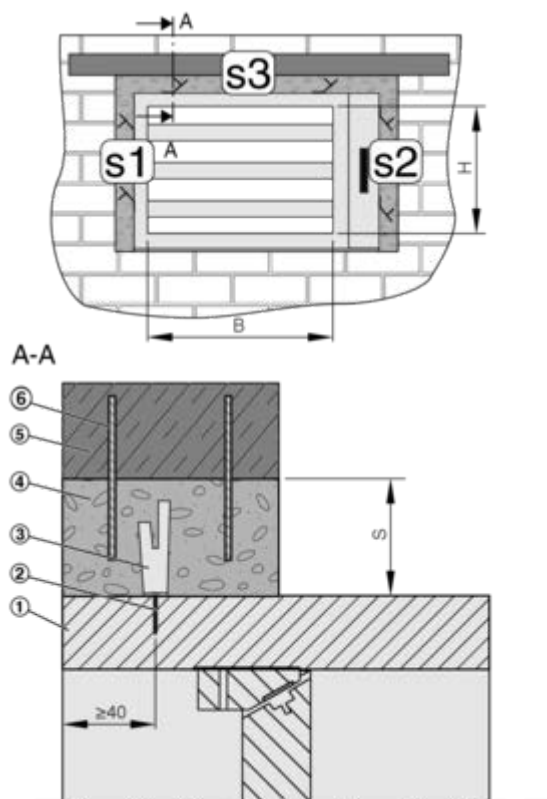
Installazione a base di malta EK-JZ con linguetta di fissaggio
